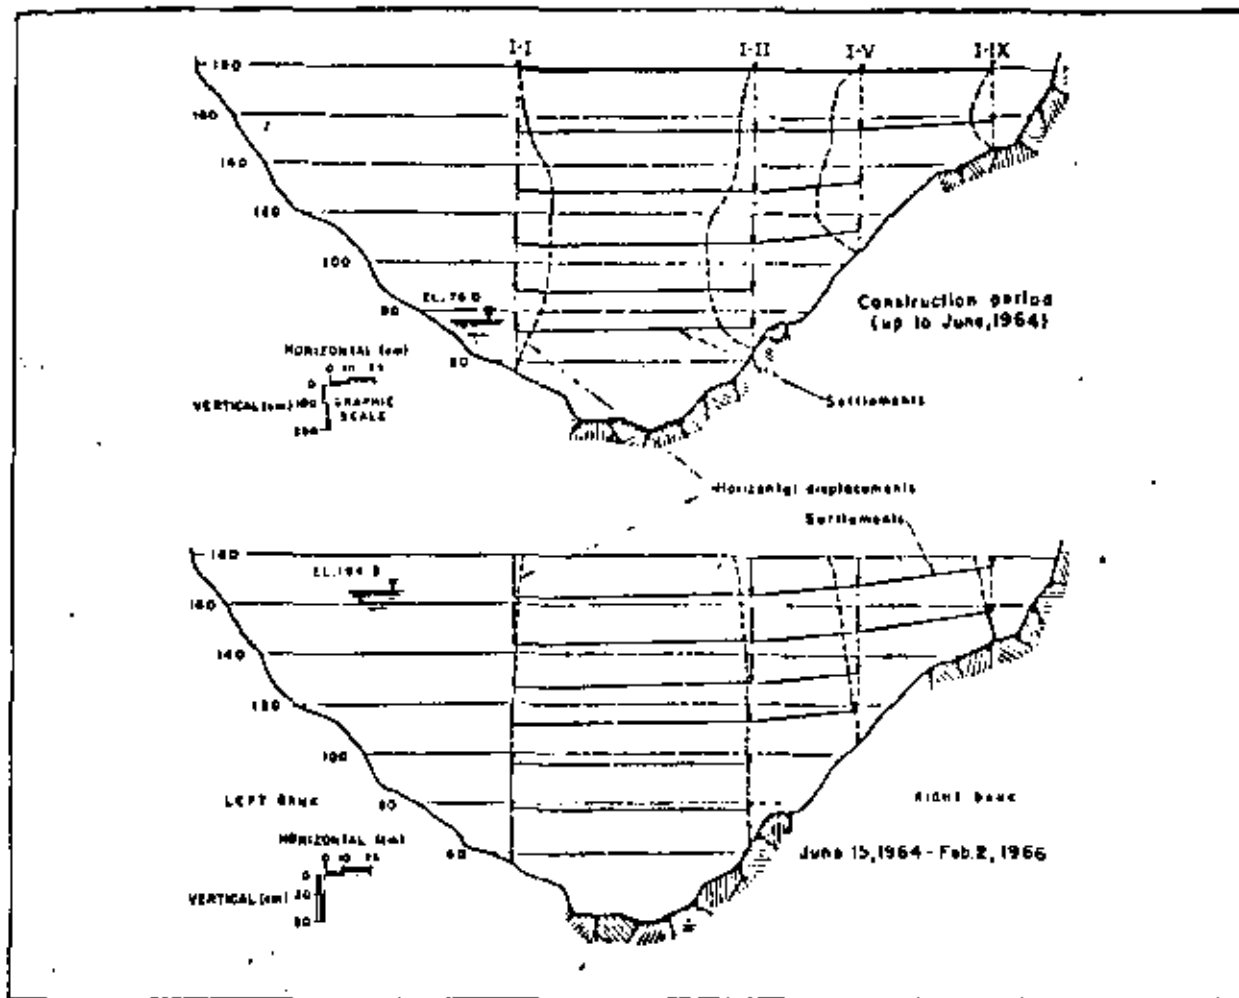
Desplazamientos horizontales a lo largo del eje y asentamientos en el corazón. Período de construcción
